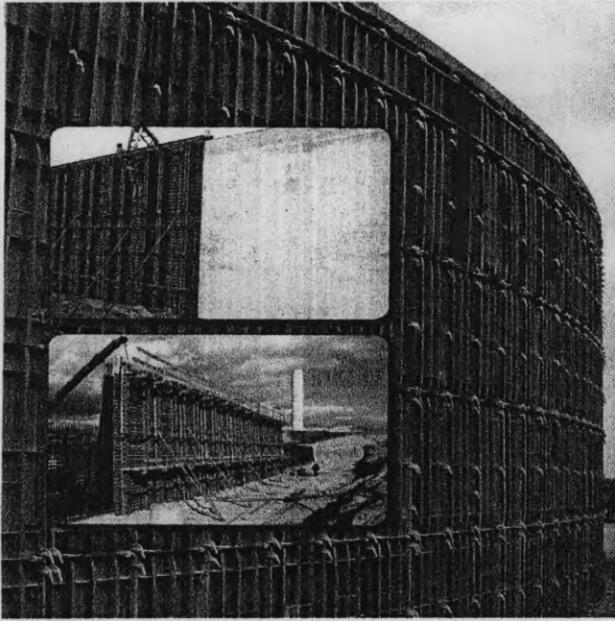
Construcción de planta de tratamiento de aguas residuales para planta de celulosa Botnia.
